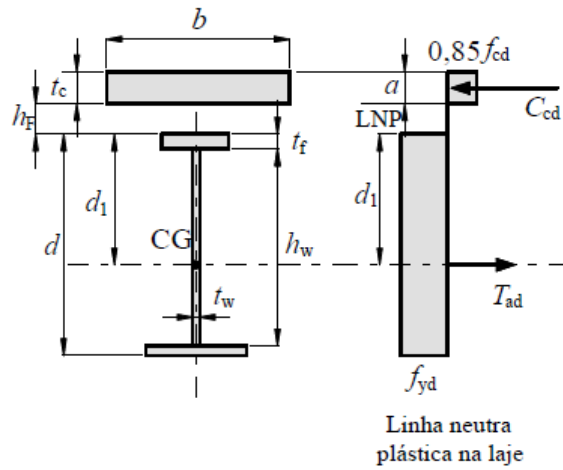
Distribuição das tensões na viga mista com linha neutra plástica na laje de concreto.
